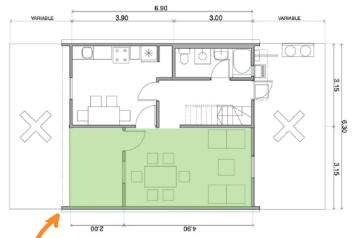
Habitação Villa Verde, Chile Planta Tipo 2 Fonte: ArchDaily
